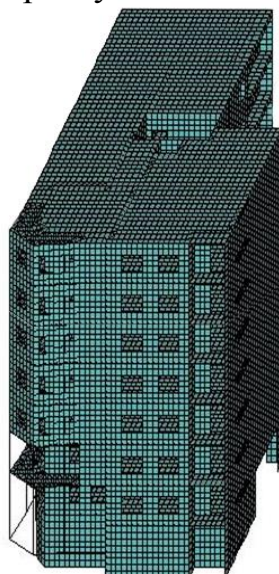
Скінченно-елементна модель монолітного залізобетонного каркасу житлової будівлі
